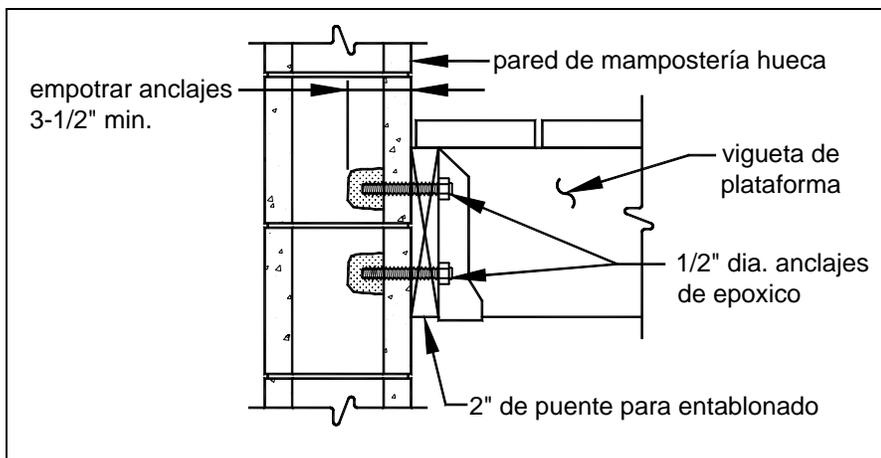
UNIÓN DEL PUENTE PARA ENTABLONADO CON LA PARED DE CIMENTACIÓN (MAMPOSTERÍA HUECA)
